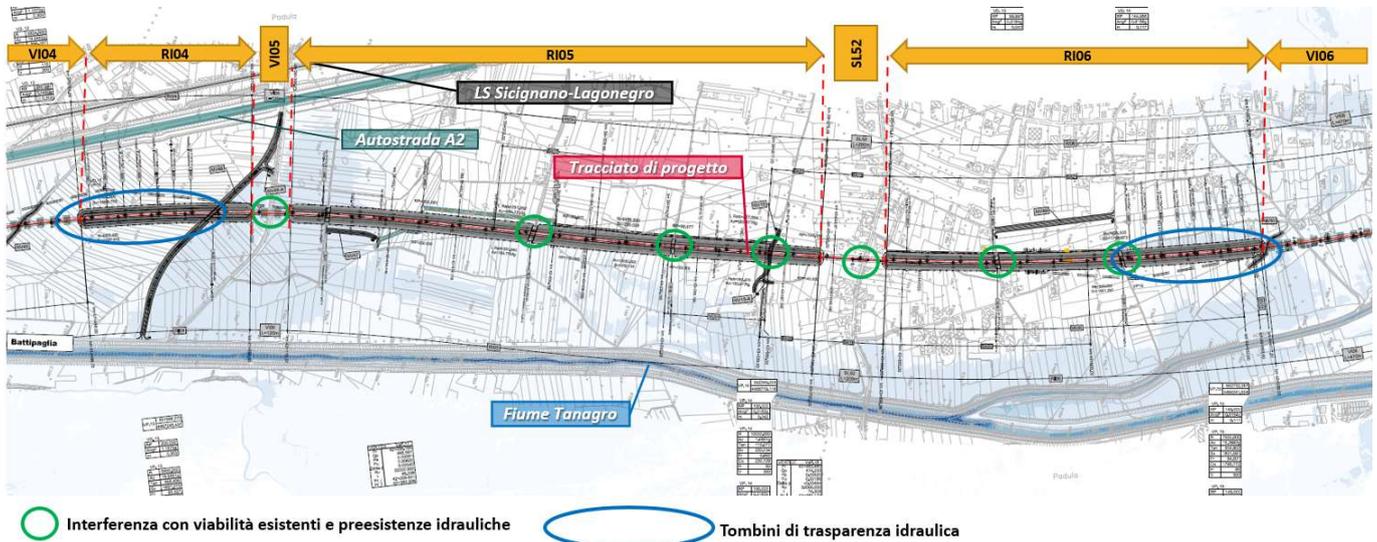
Planoprofilo di progetto da km 41+486 a km 45+026
